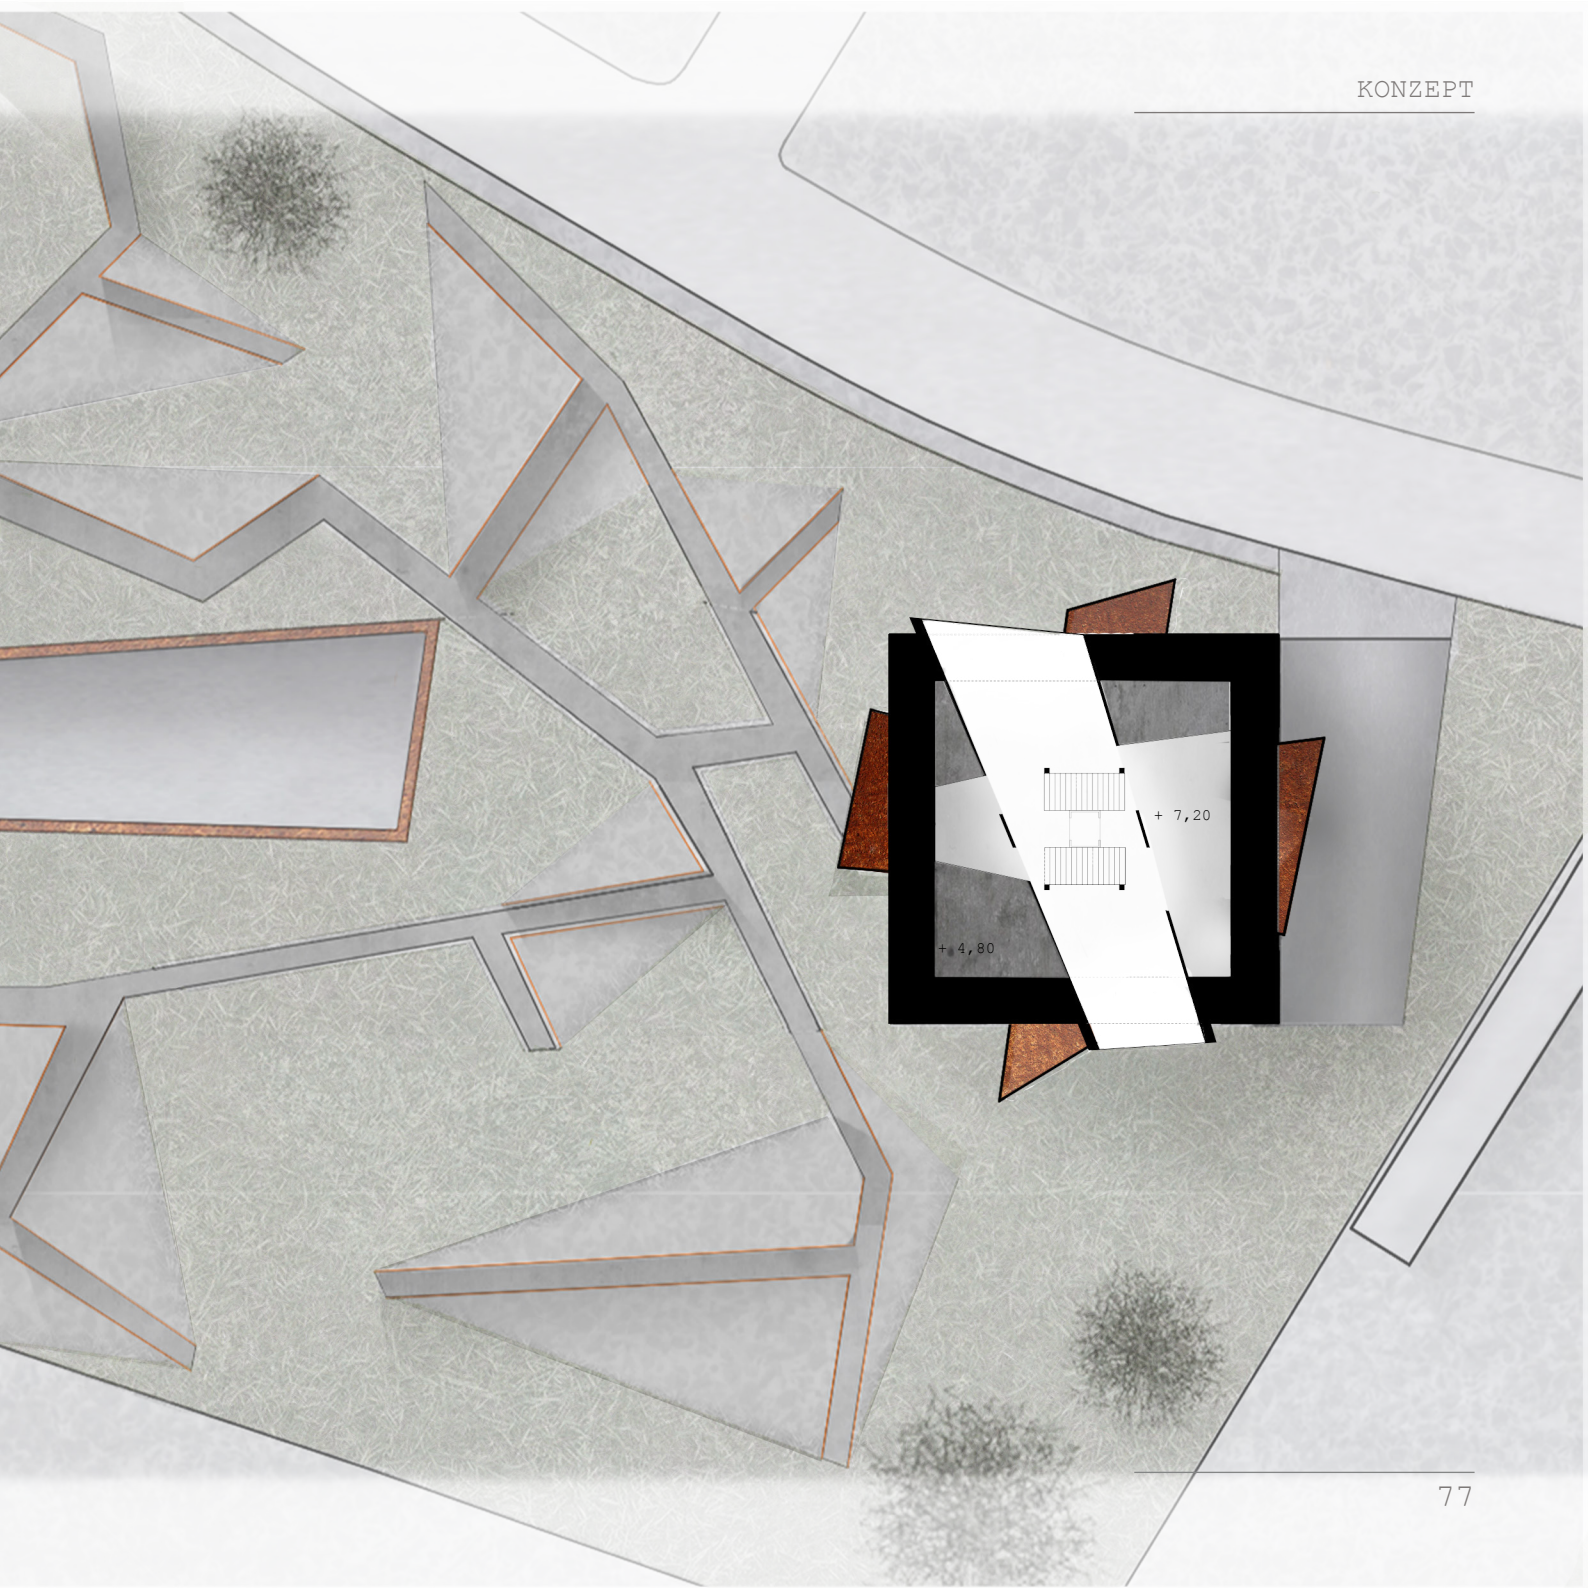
Grundriss - viertes Stockwerk
